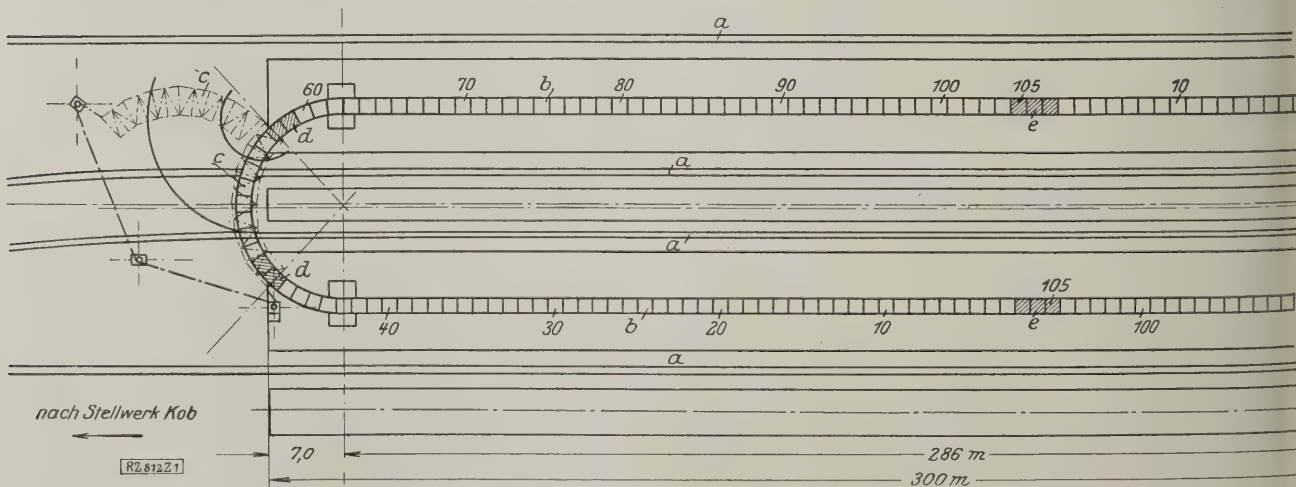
Schema der Güterumladeanlage auf dem Umladebahnhof Bebra.
